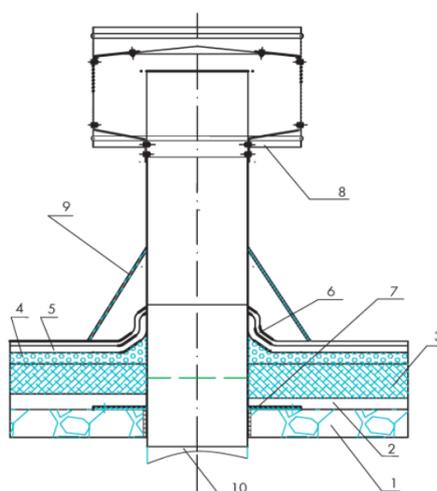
Схема вентиляционного узла мусоропровода: 1) плита перекрытия; 2) пароизоляция; 3) теплоизоляция; 4) выравнивающая стяжка с бортиком из цементнопесчаного раствора; 5) основной водоизоляционный слой; 6) дополнительные слои водоизоляционного кровельного материала; 7) гильза; 8) дефлектор; 9) фартук; 10) труба вентиляционная
